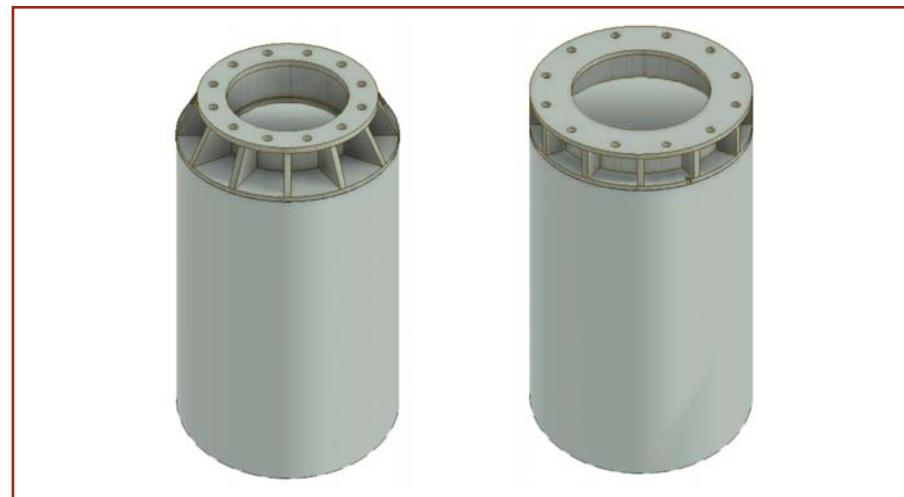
Узлы соединения фундаментных секций с промежуточными и анкерно-угловыми железобетонными опорами
